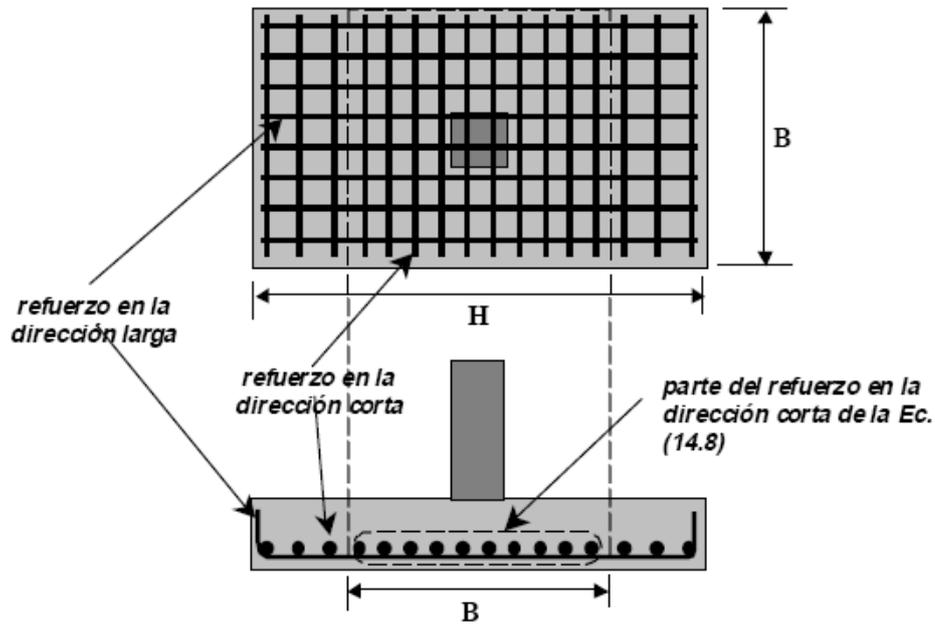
Distribución del refuerzo en zapatas rectangulares aisladas
